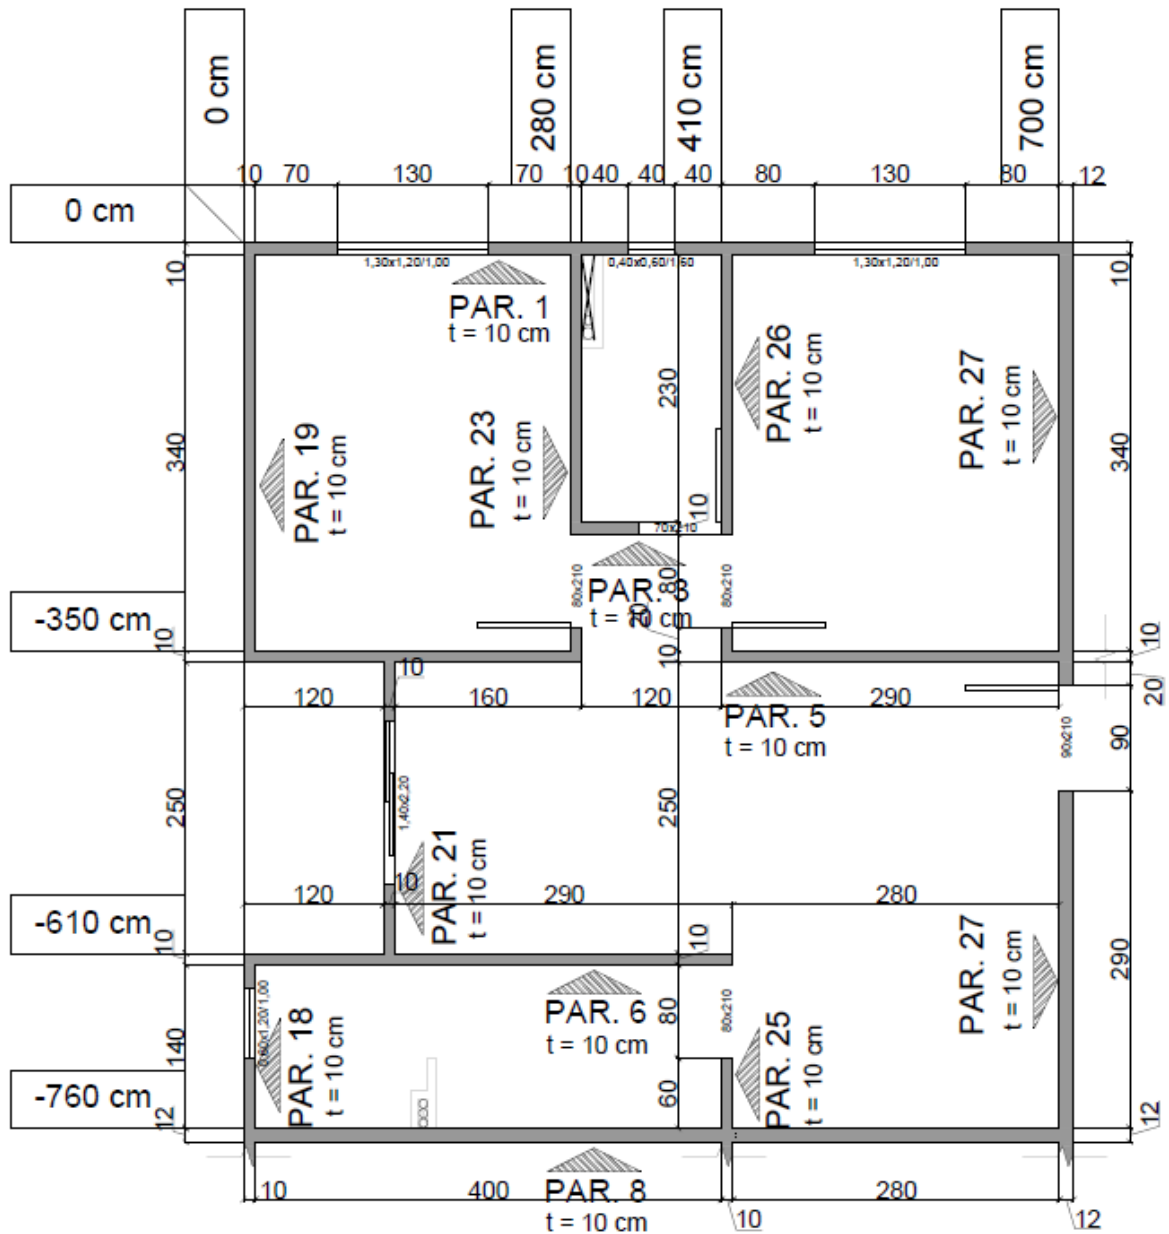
Planta do edifício com quatro apartamentos por andar.
